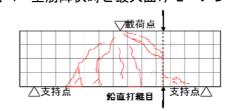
打継面の目粗し試験体のひび割れ状況
